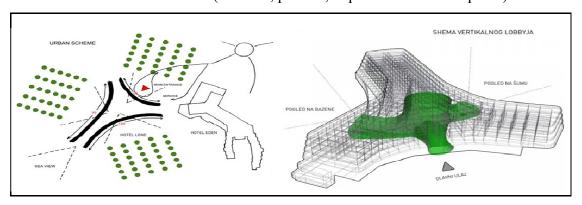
Structure du projet. Source : www.positive-magazine.com
